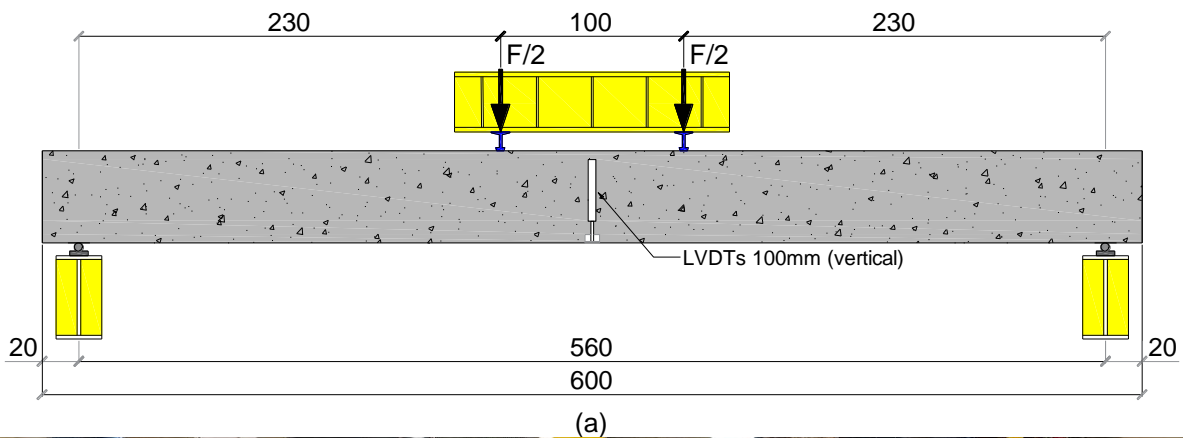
Configuração do ensaio de flexão das vigas – dimensões em cm (Autores)
